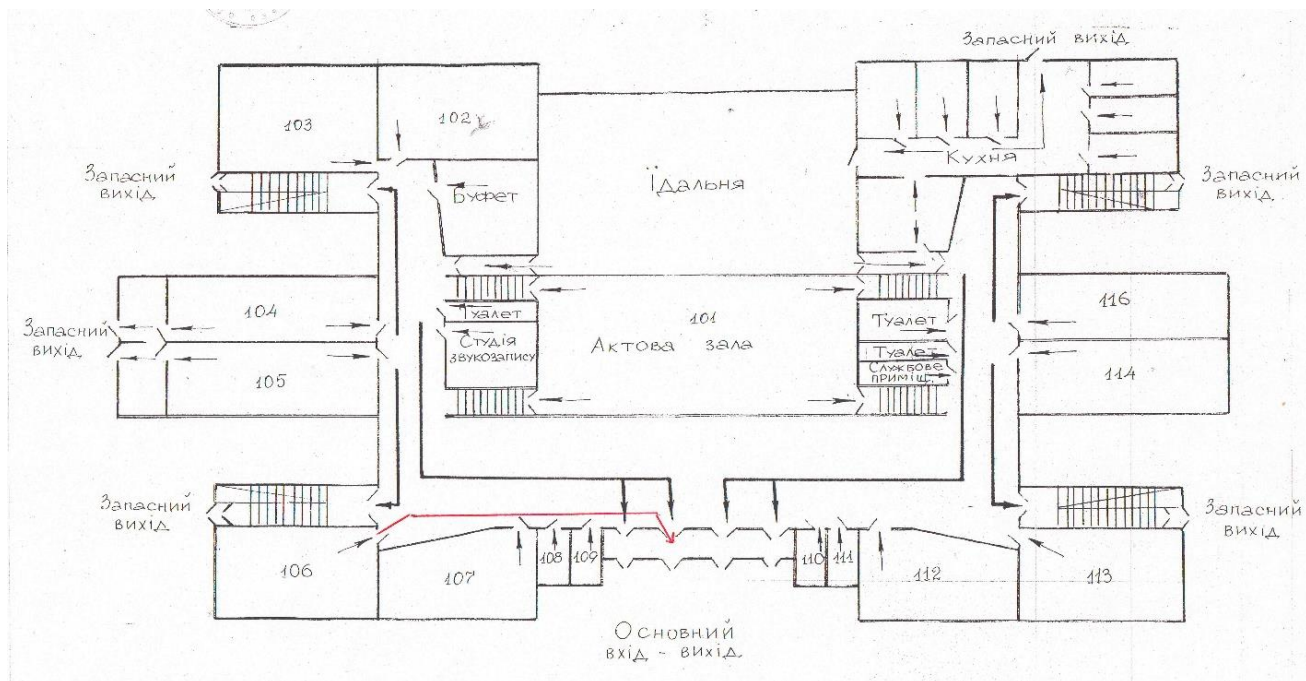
План 1-го поверху БАЛ «Гармонія»
